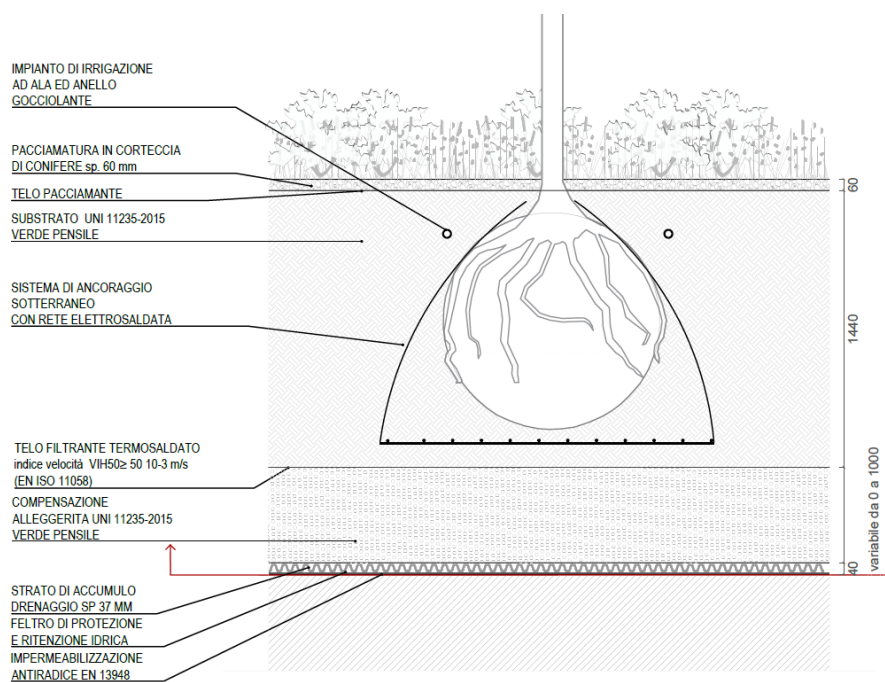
Dettaglio del pacchetto di riempimento previsto sulla piastra verde
